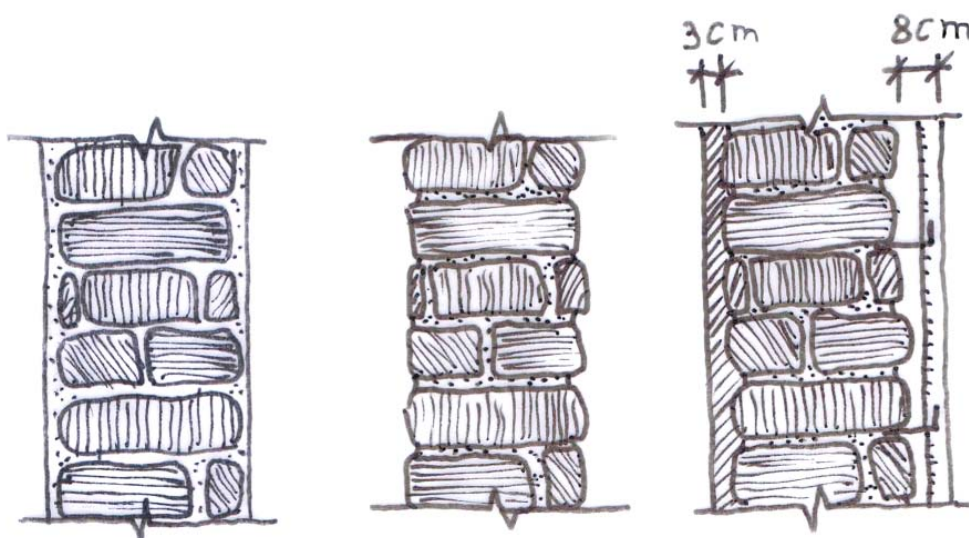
| Reforço de alvenaria com lâmina de betão armado numa face e apenas reboco noutra (adaptado de [2])
